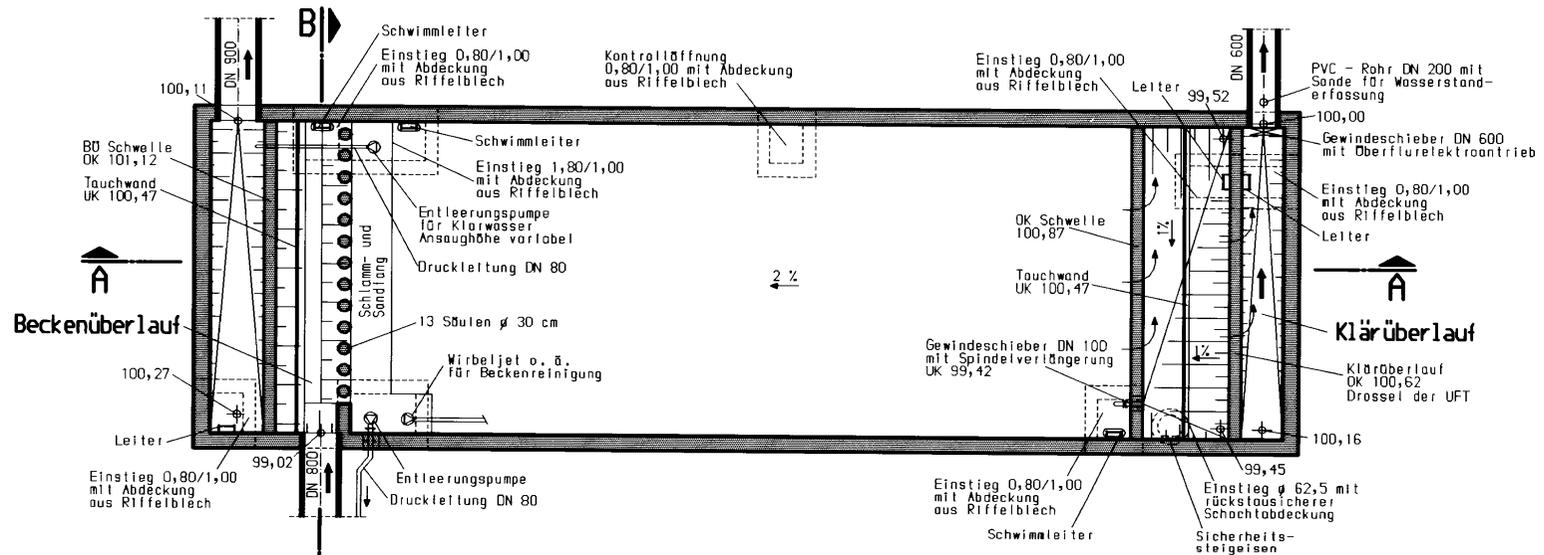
Regenklärbecken in Betonbauweise mit teilweiser Entleerung in den Schmutzwasserkanal
